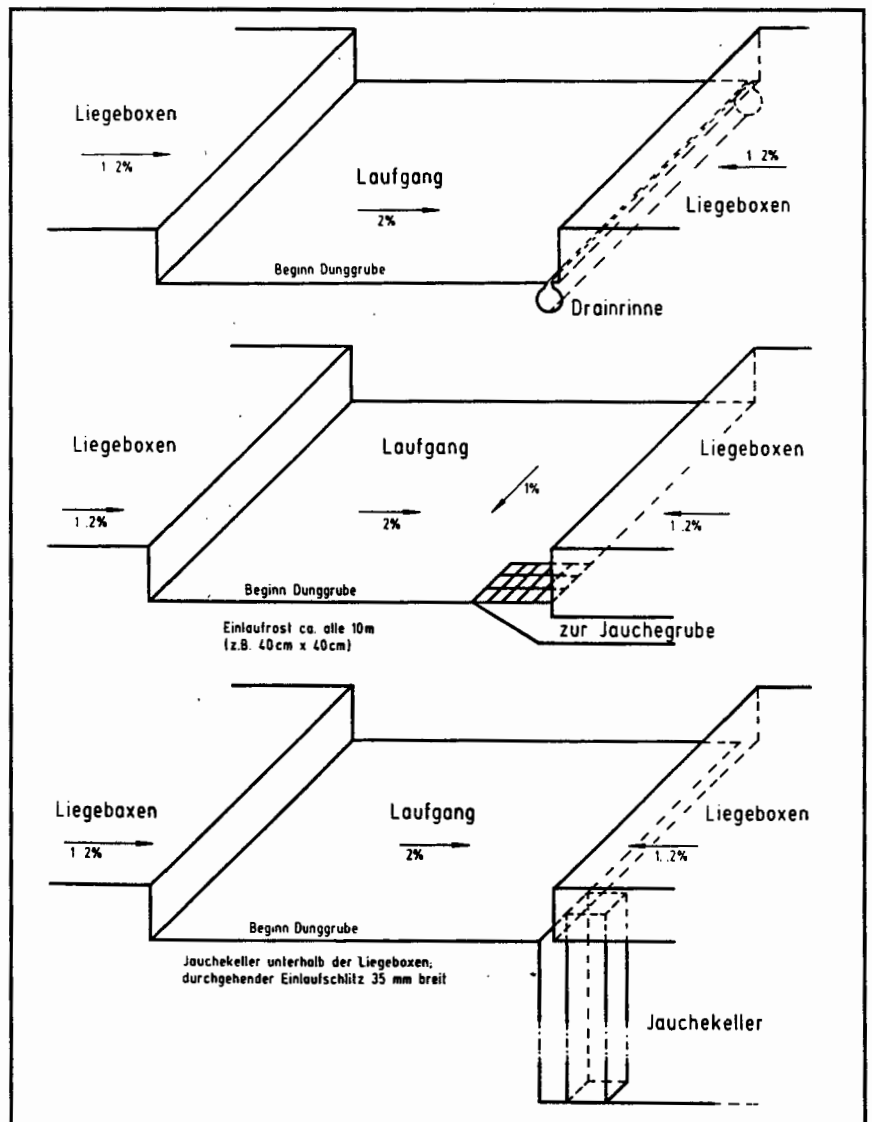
Drei Vorschläge für die Bauausführung zur Entwässerung der Laufflächen
